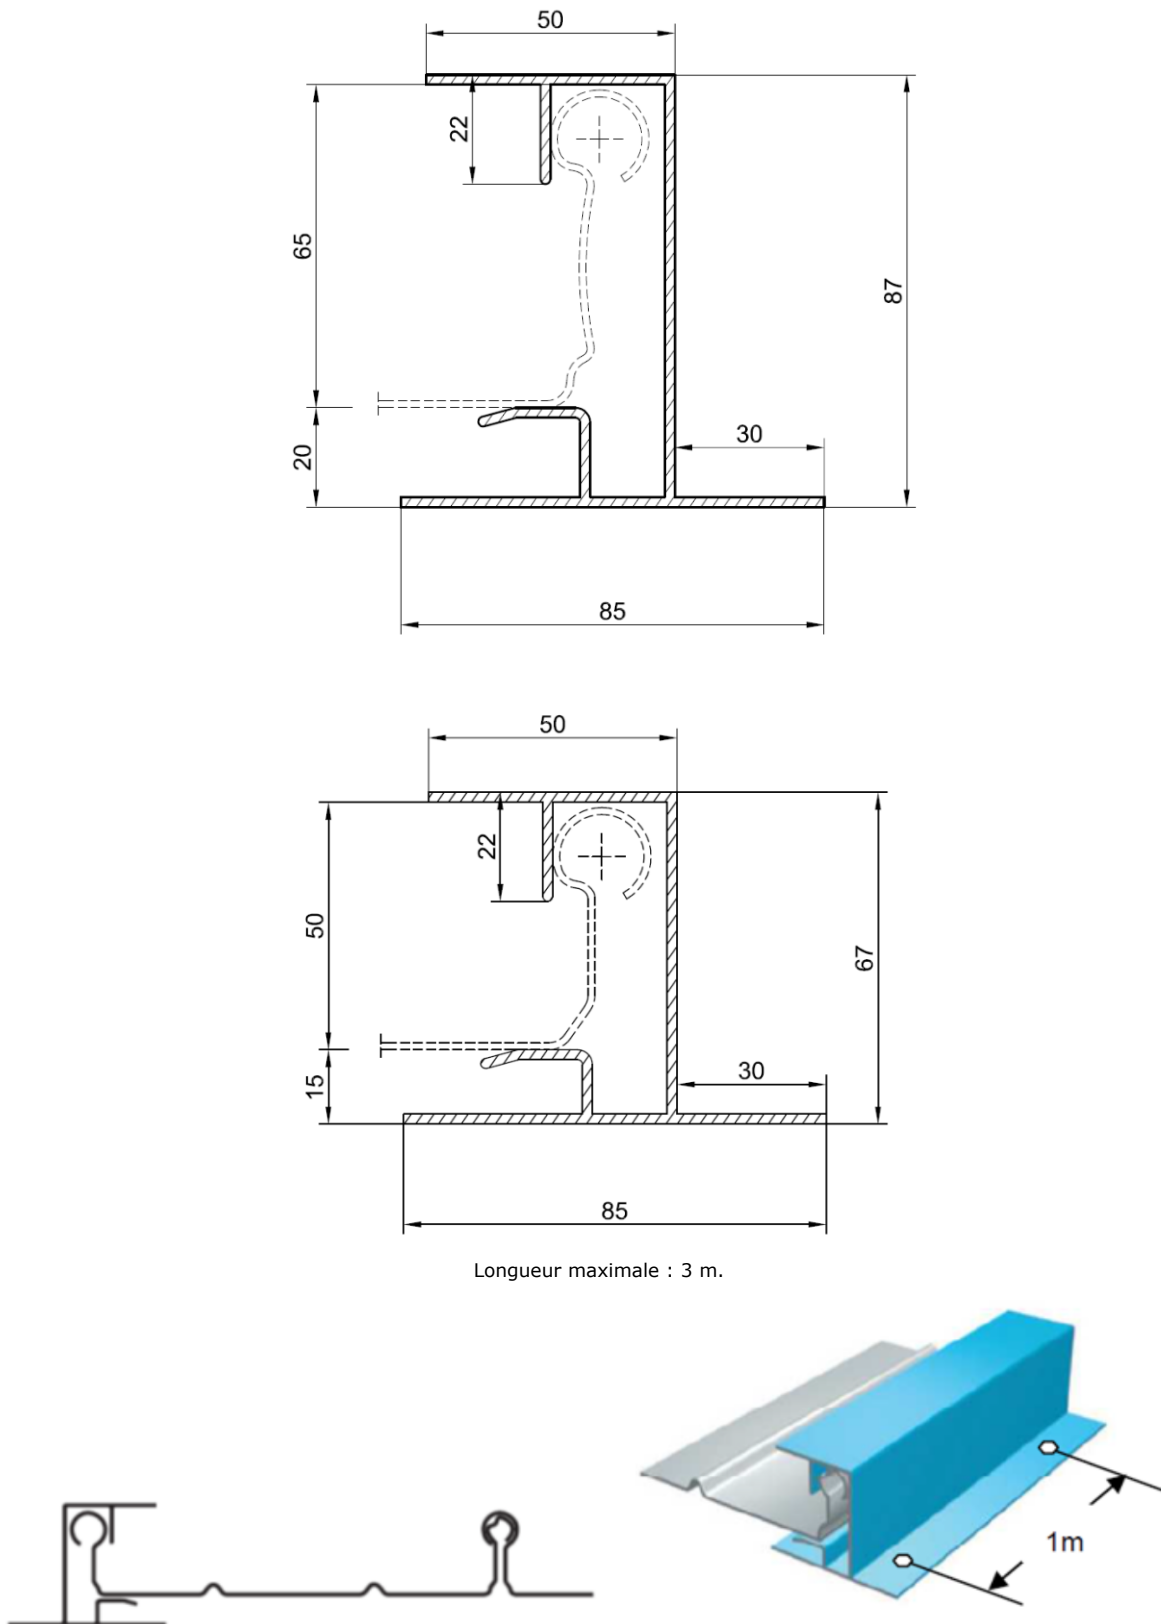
Profil de rive tout-en-un : hauteur 50 pour les profils de type Kalzip® 50, AF 65 ou AS 65, hauteur 65 pour les profils de type Kalzip® 65
